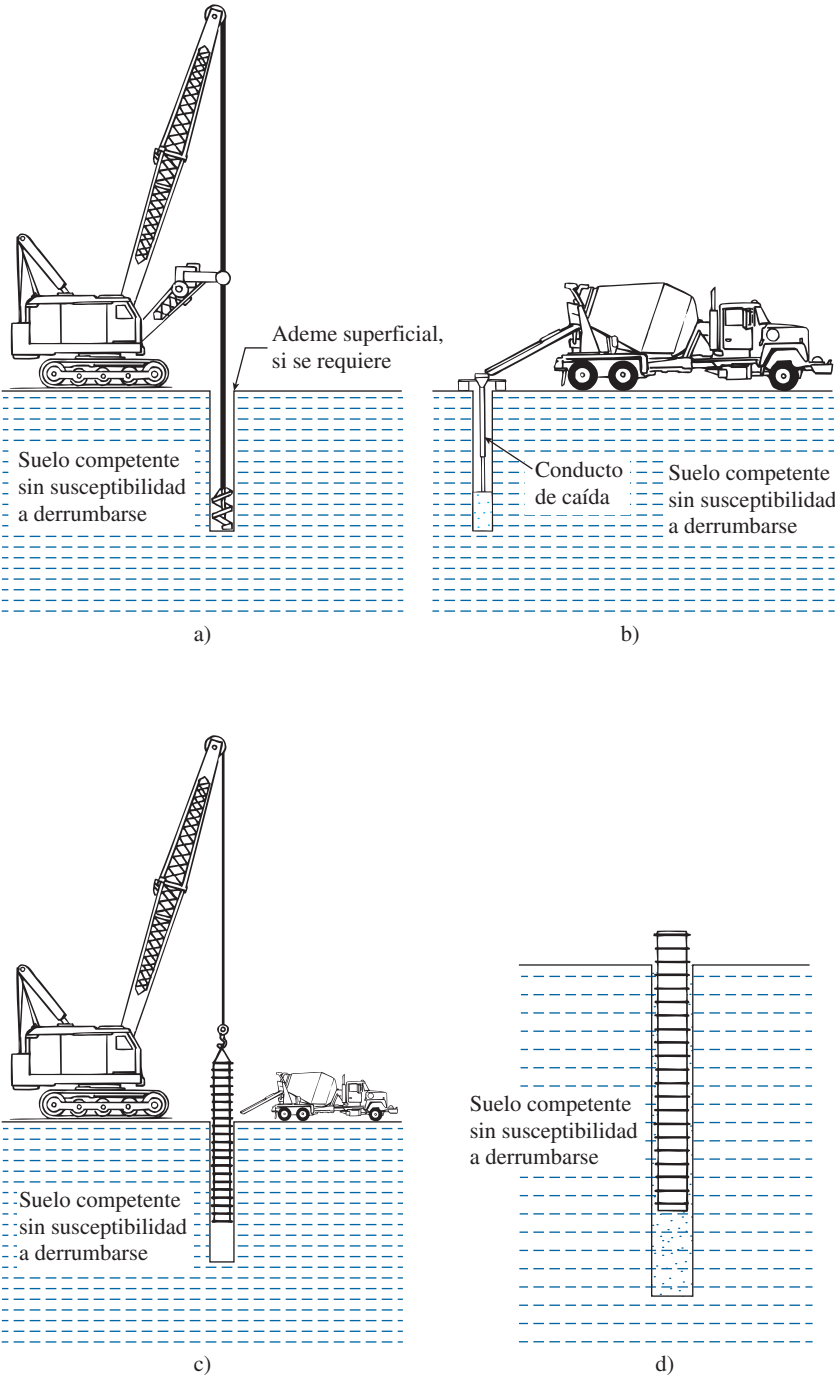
Método de construcción seco: a) perforación inicial; b) inicio del vertido del concreto; c) colocación de la jaula de varillas de refuerzo; d) pila completada. (Según O'Neill y Reese, 1999)
